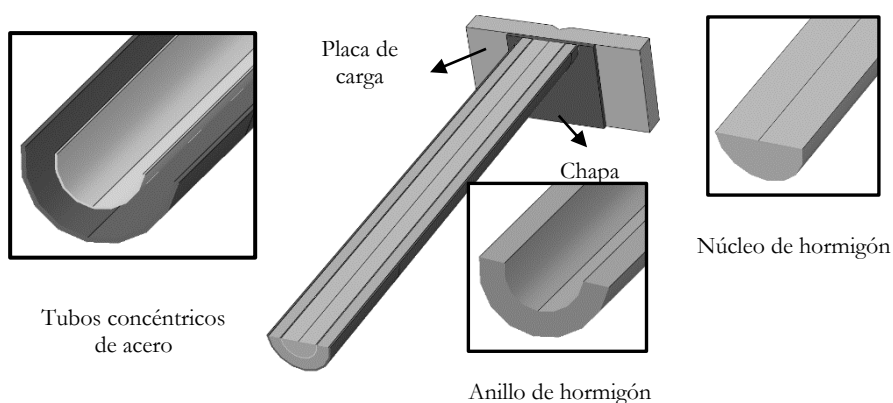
Ensamblaje de las partes del modelo en columna doble tubo (CFDST).
